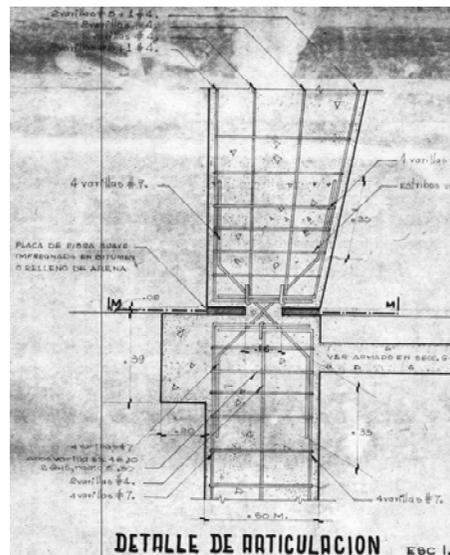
Detalle de la articulación de los marcos de concreto preesforzado.
